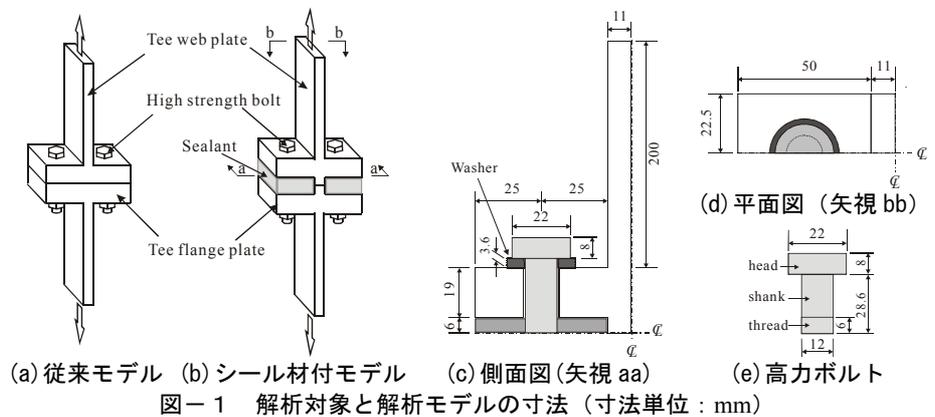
解析対象と解析モデルの寸法（寸法単位：mm）
